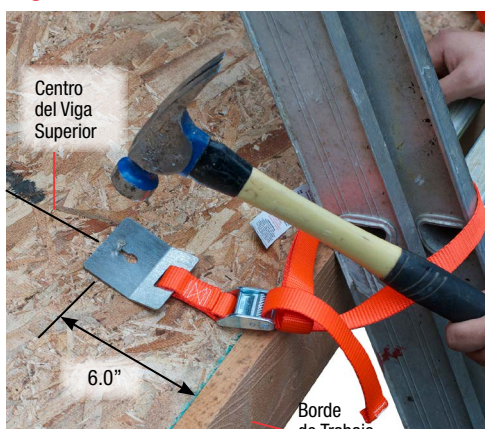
Instalación Sobre Armazones de Madera Recubiertas
